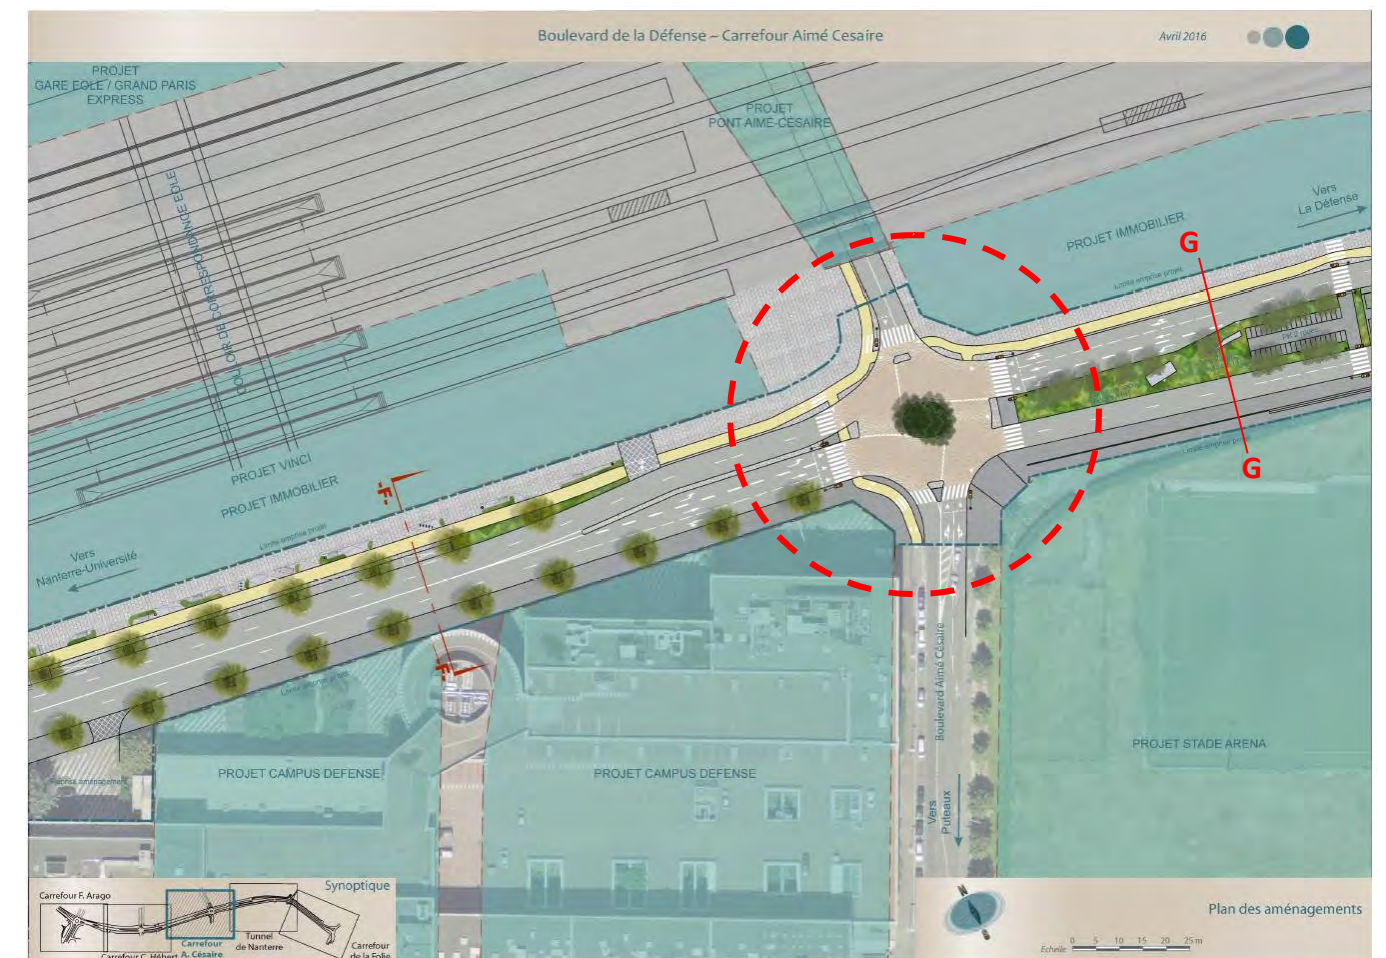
Vue en plan paysagère au droit du carrefour Aimé Césaire
